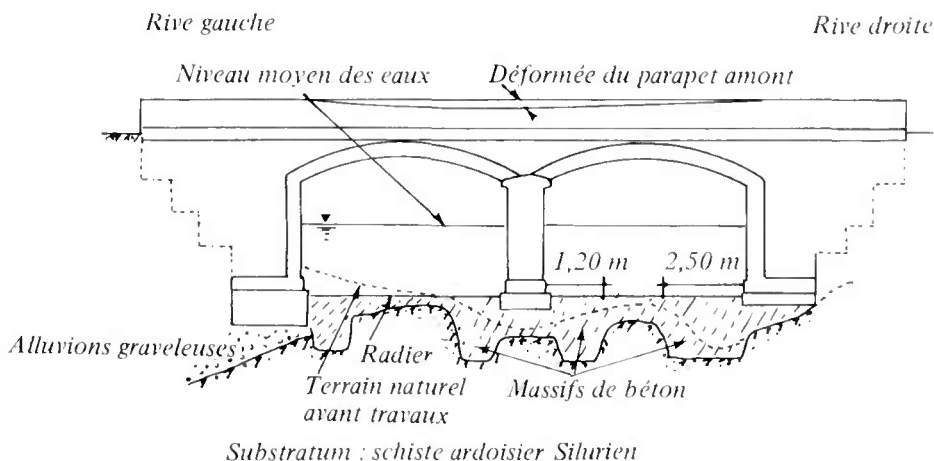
Pont de Régereau. Coupe longitudinale des travaux effectués.
